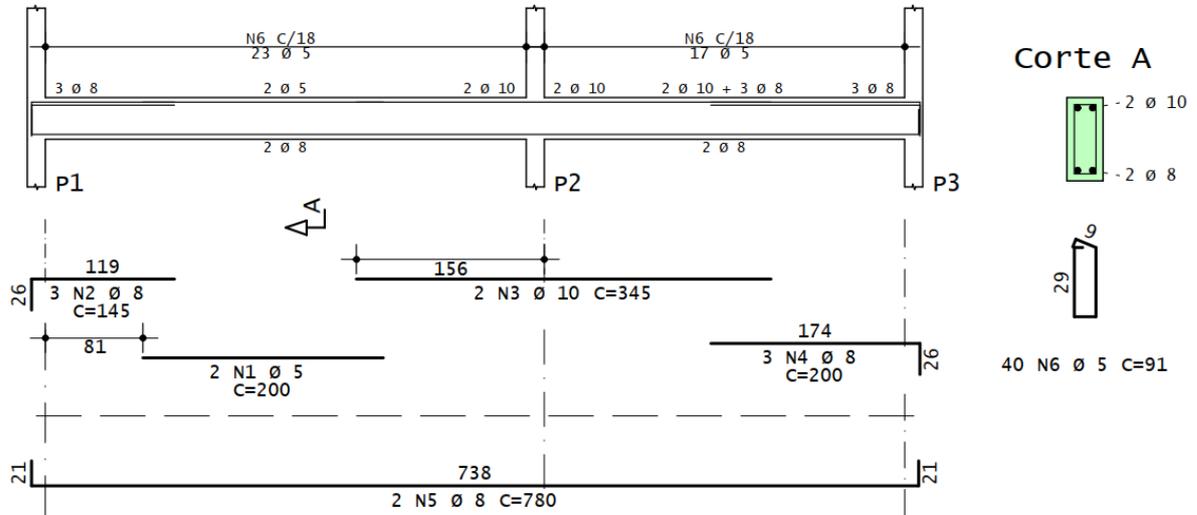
Armadura da viga baldrame V2 – pavimento térreo (nível 0,00)
